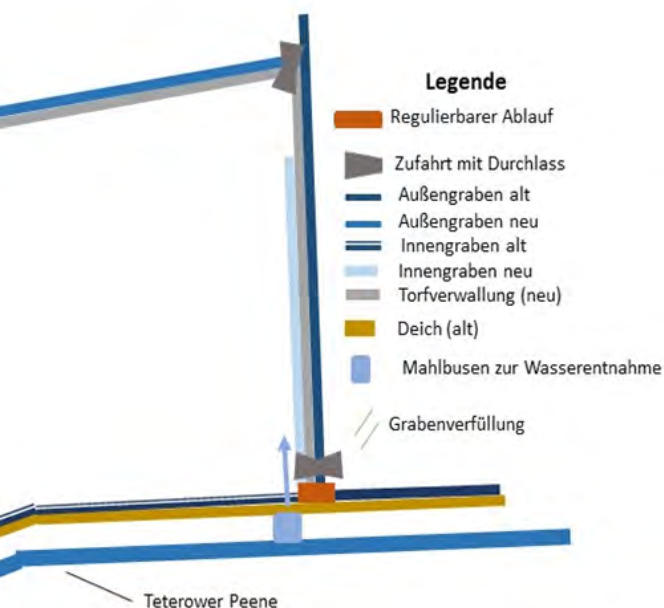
Übersicht Flächeneinrichtung Rohrkolbenanbau mit Baumaßnahmen.
